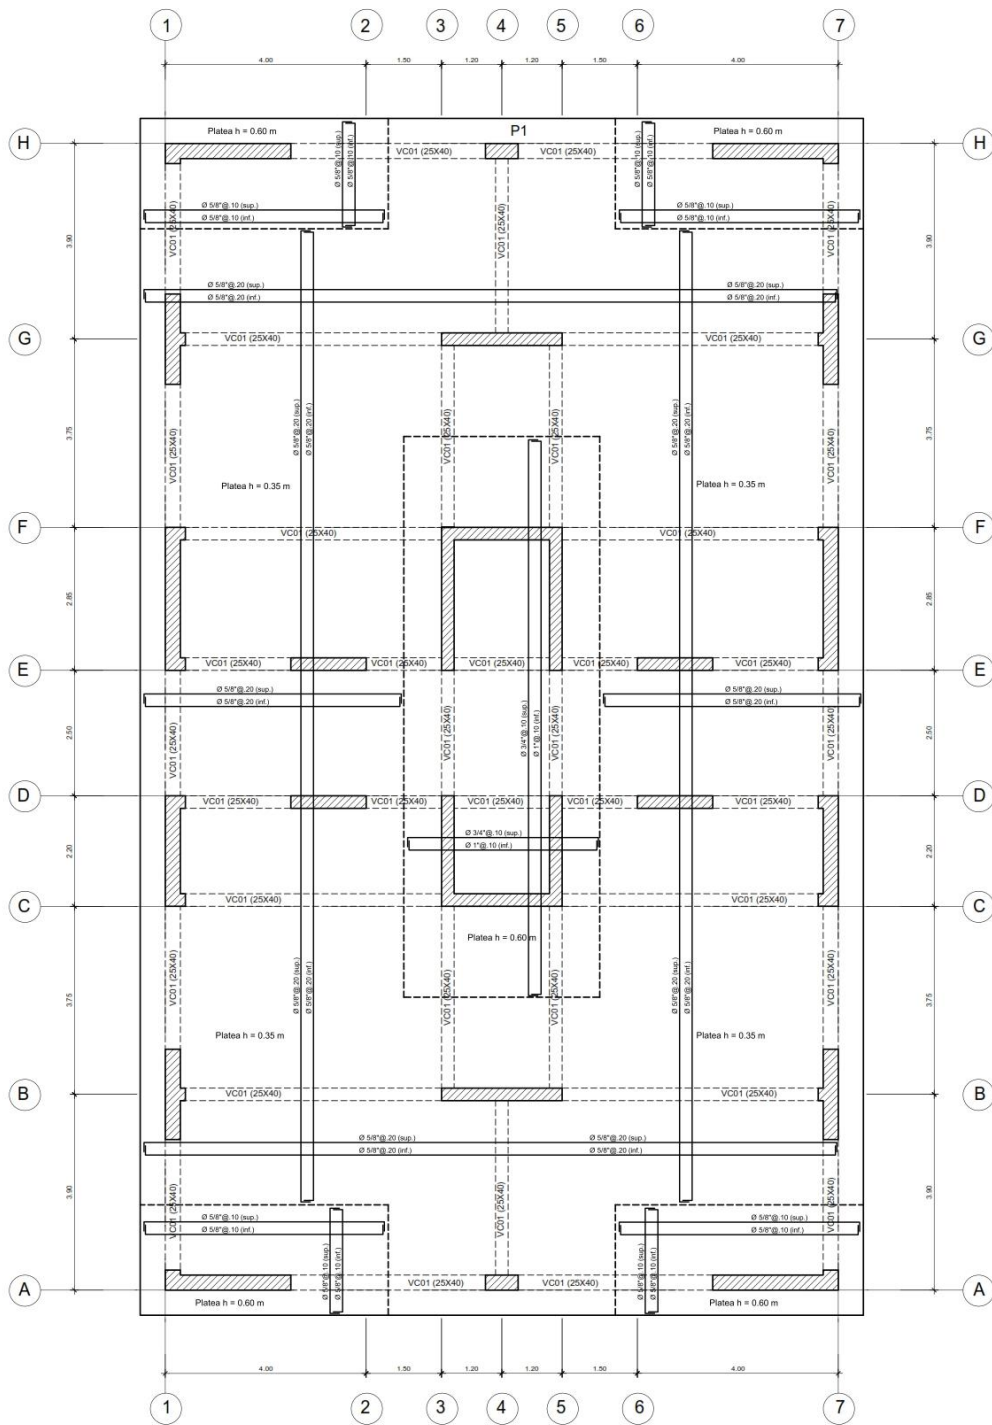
Refuerzo final en placa de cimentación de edificación convencional
